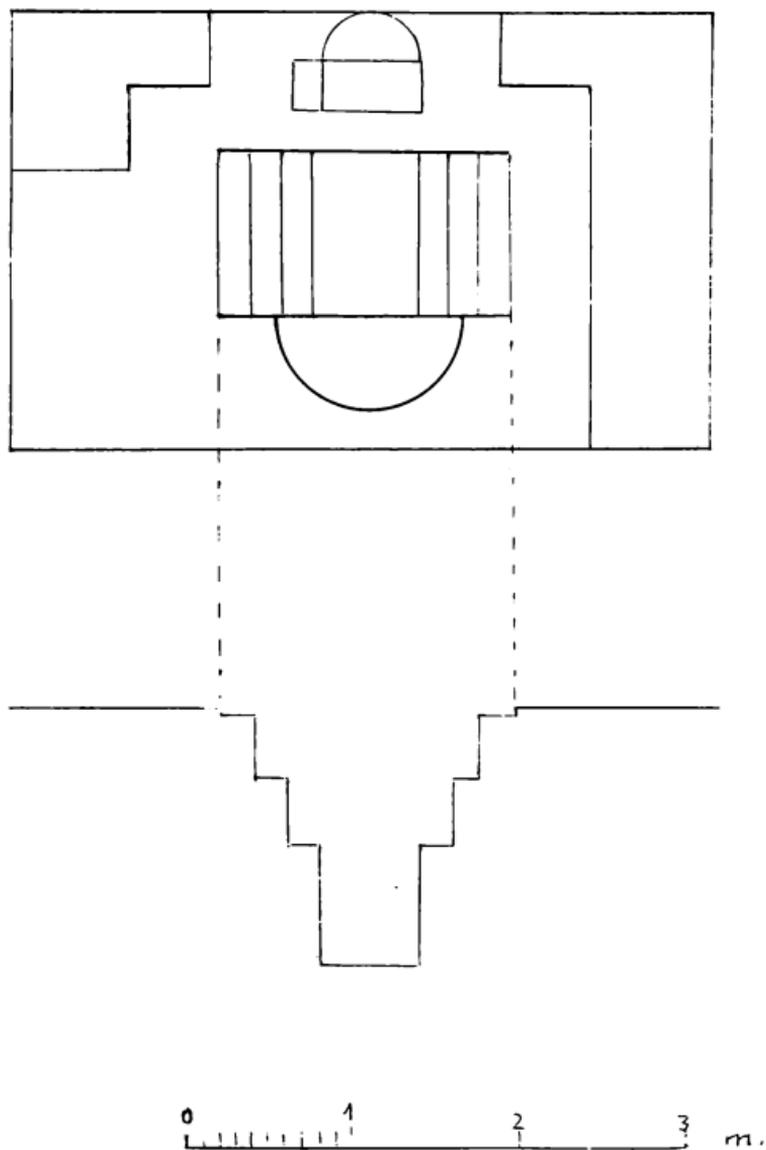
Planta del baptisterio de las vegas de pedrazaa y seccion vertical de la piscina mayor.
